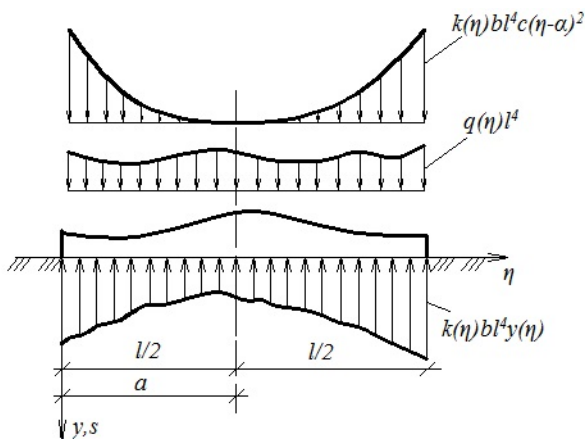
Эквивалентная расчетная схема балочного фундамента на набухающих грунтах
